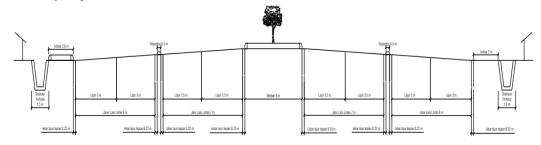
ROW Road section RSAI – UNINUS Sukarno Hatta Highway, Bandung
